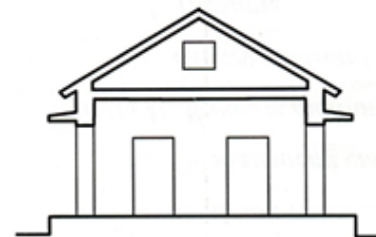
Утворення поперечного та поздовжнього розрізу будівлі
